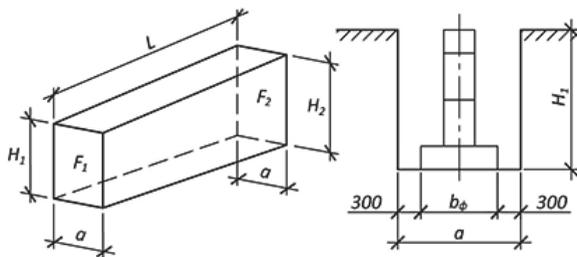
Схема траншеи с вертикальными стенками и разными глубинами
